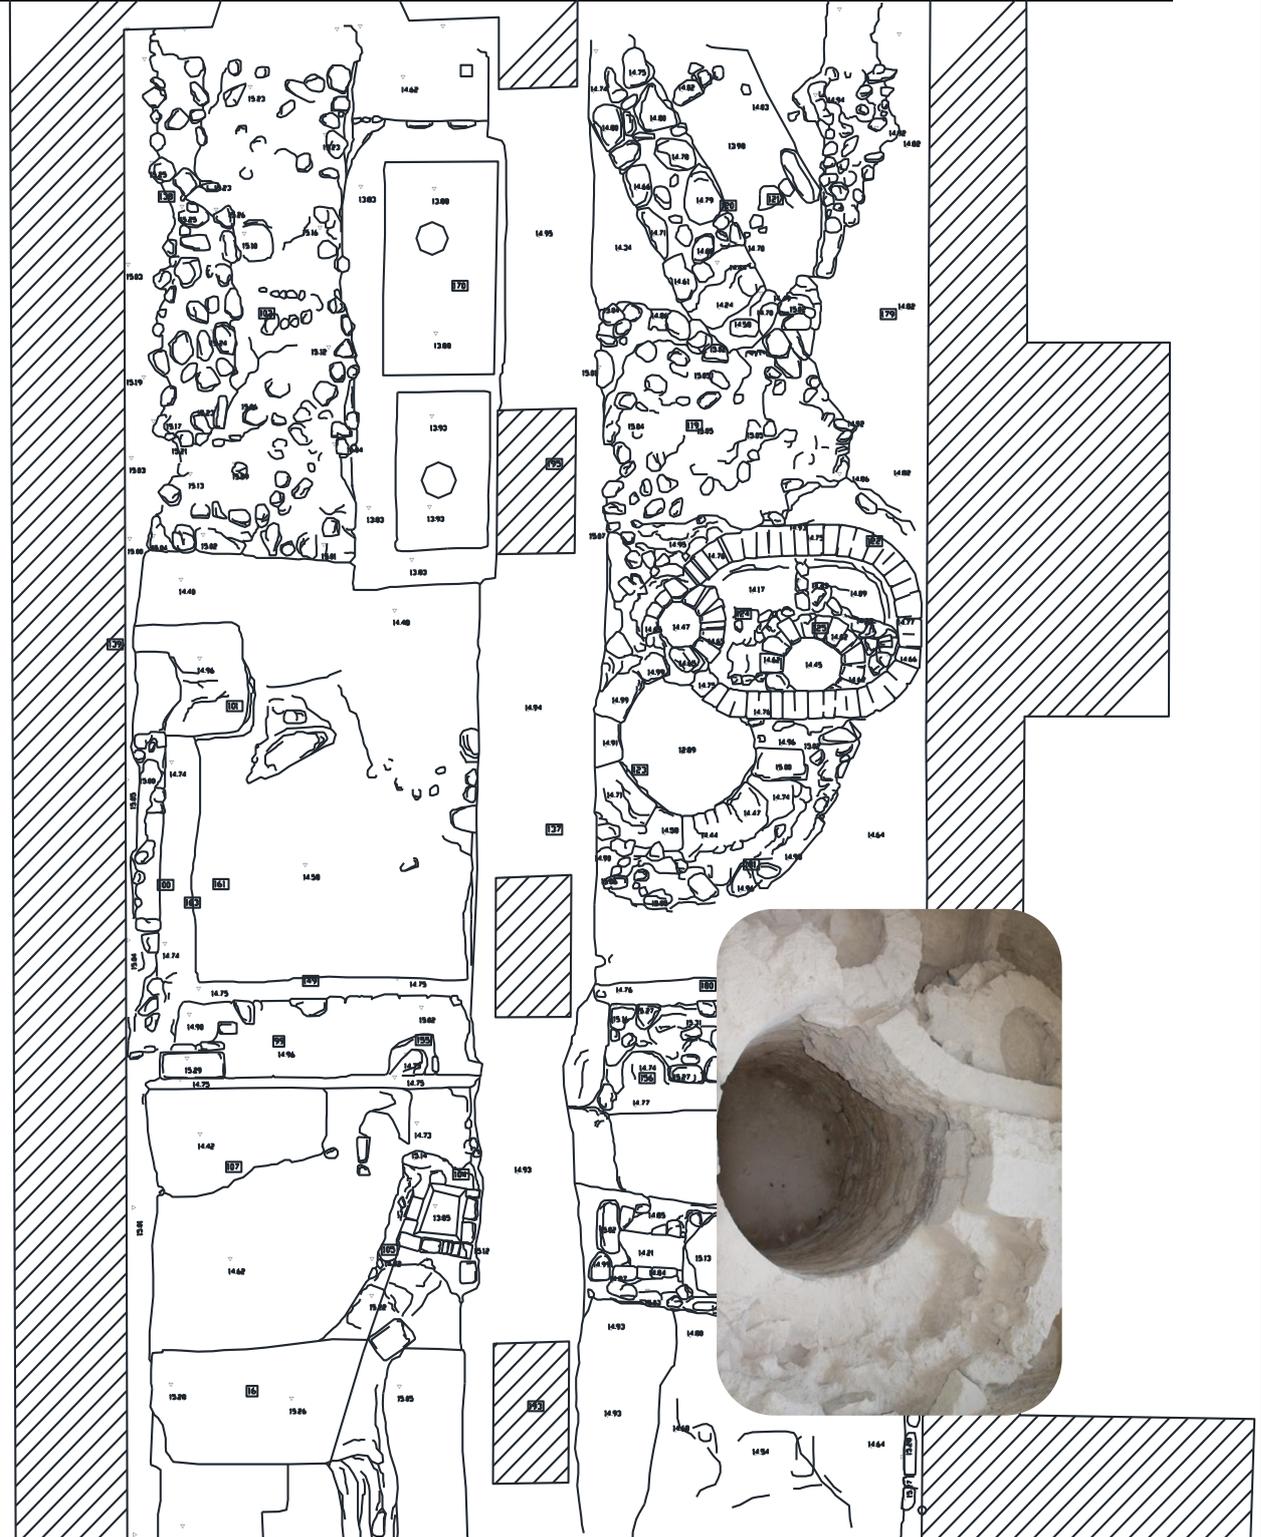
Detalle del plano de la nave lateral izquierda. Representación de las estructuras bajo el subsuelo del Alhorí. Detalle de estructura para almacenamiento de agua¹⁶¹
